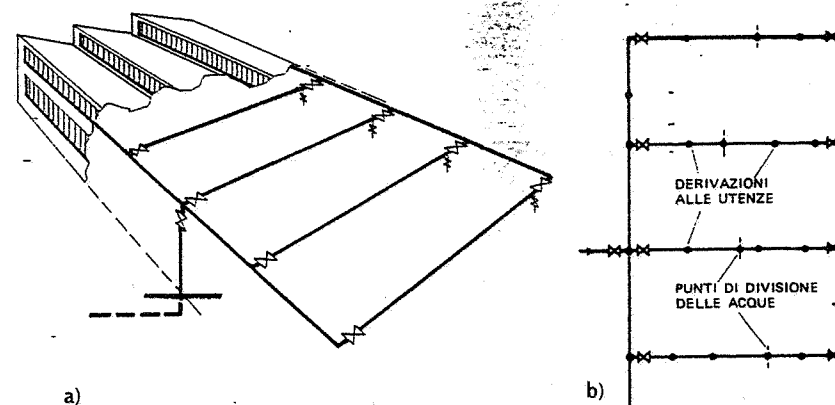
Rete a maglia: a) prospettiva; b) pianta.
